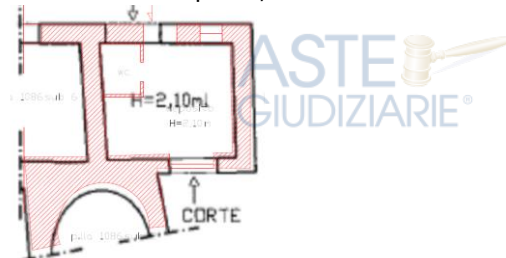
sovrapposizione della situazione reale dei luoghi e della planimetria catastale del locale adibito a deposito.
